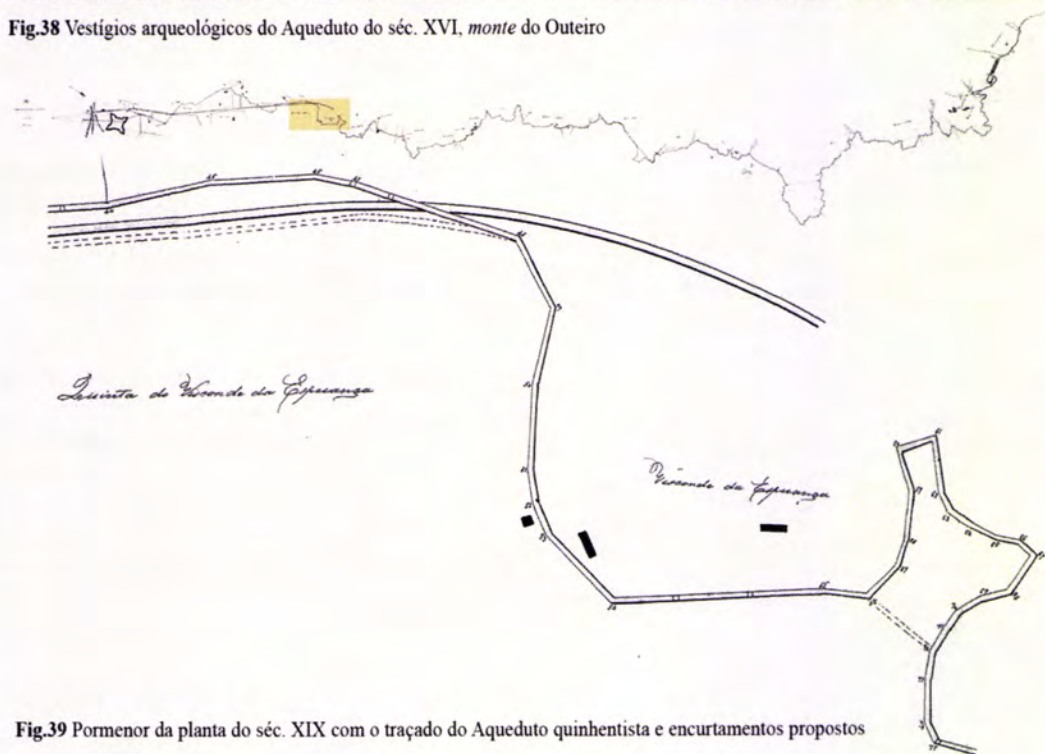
Pormenor da planta do séc. XIX com o traçado do Aqueduto quinhentista e encurtamentos propostos
